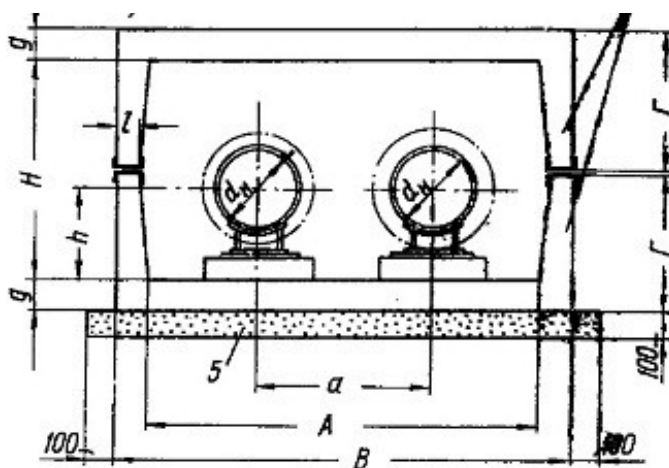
Унифицированные железобетонные каналы из сборных плит типа СК
